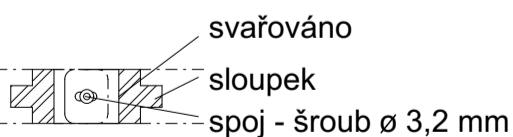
DETAILA - KOTVENÍ ZÁBRADLÍ M 1:10
